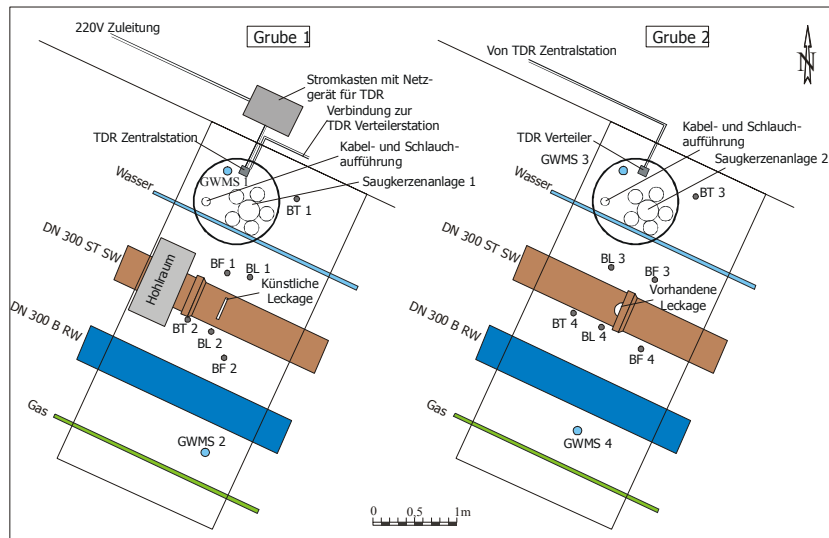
Detailplan der Instrumentierung der Gruben 1 und 2 der Kanalteststrecke Rastatt/Kastanienweg (EISWIRTH 2002).
